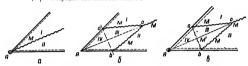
Схемы образования линий разрушения в углах плит, опертых по контуру.
